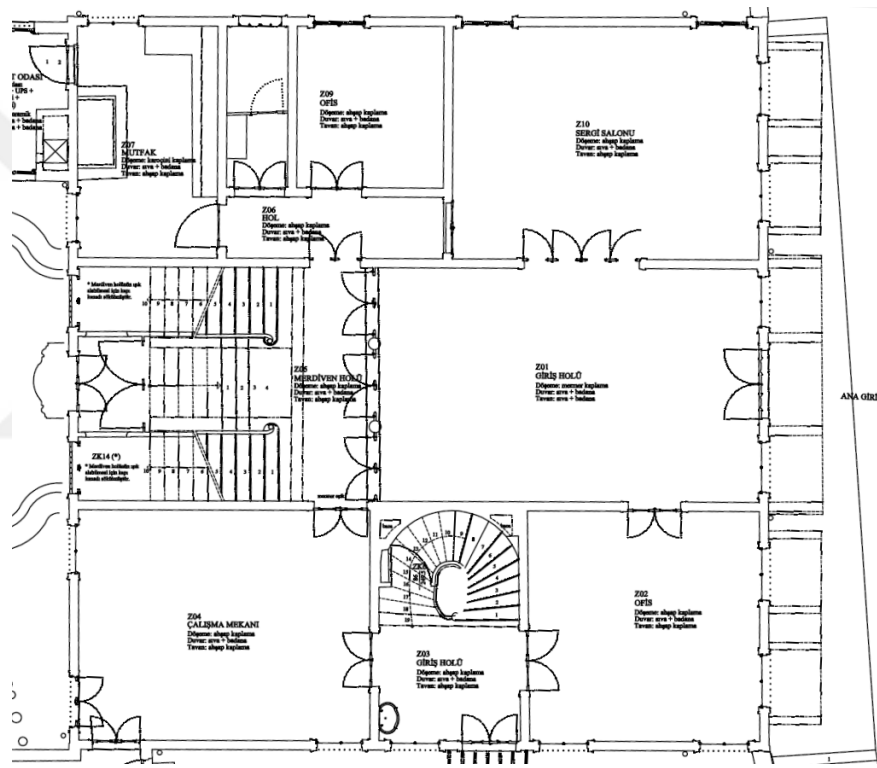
HÇY Vaziyet Planı (Restitüsyon Projesi, 2014)
